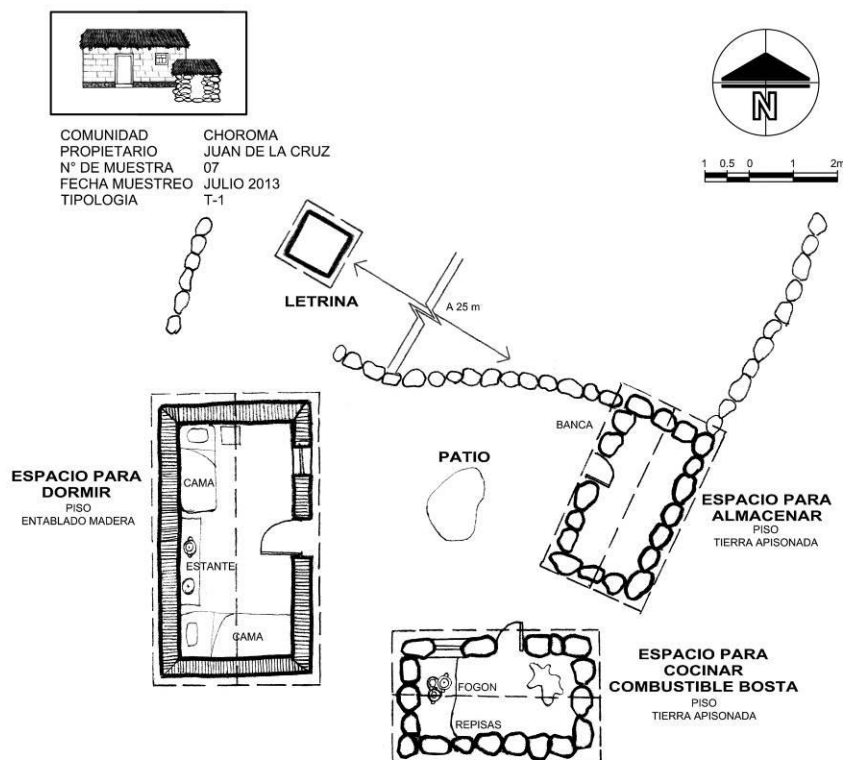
Planta de una vivienda autóctona (Fuente: Elaboración propia)
